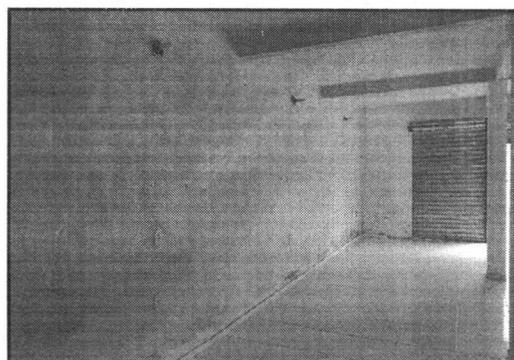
Vista do Salão central, com iluminação em paredes e pintura desgastada
